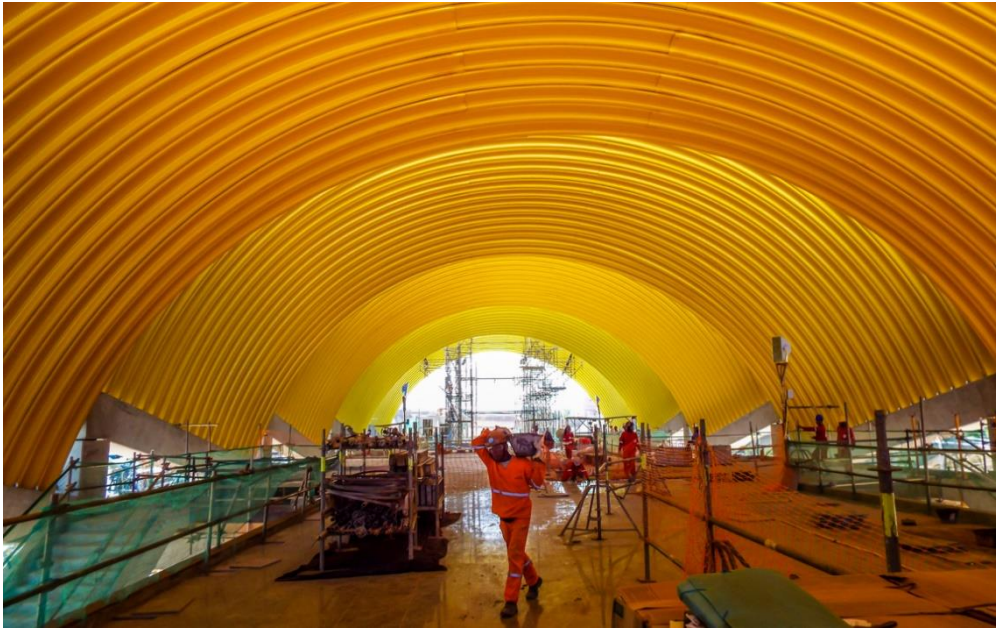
Foto da Estação típica em construção, vista do mezanino (Fonte: Skyscrapercity)
